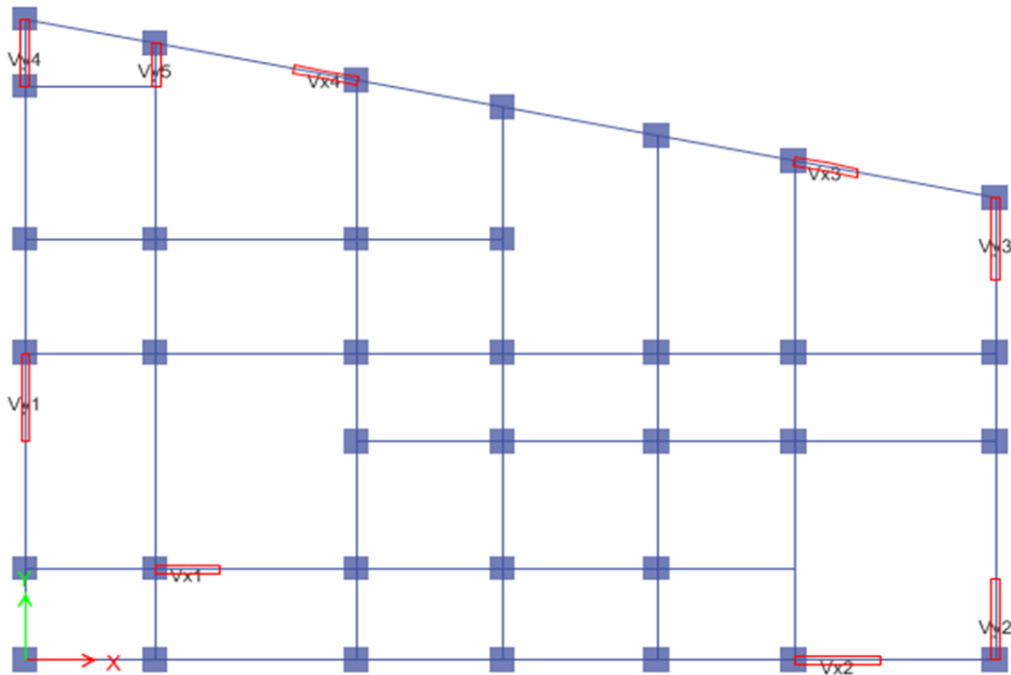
Vue en plan des éléments structuraux (Poteaux-Voiles) de la superstructure.
